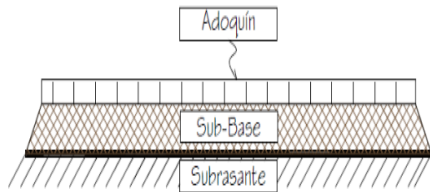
Sección típica transversal pavimento flexible - Fuente: Armijos 2009
